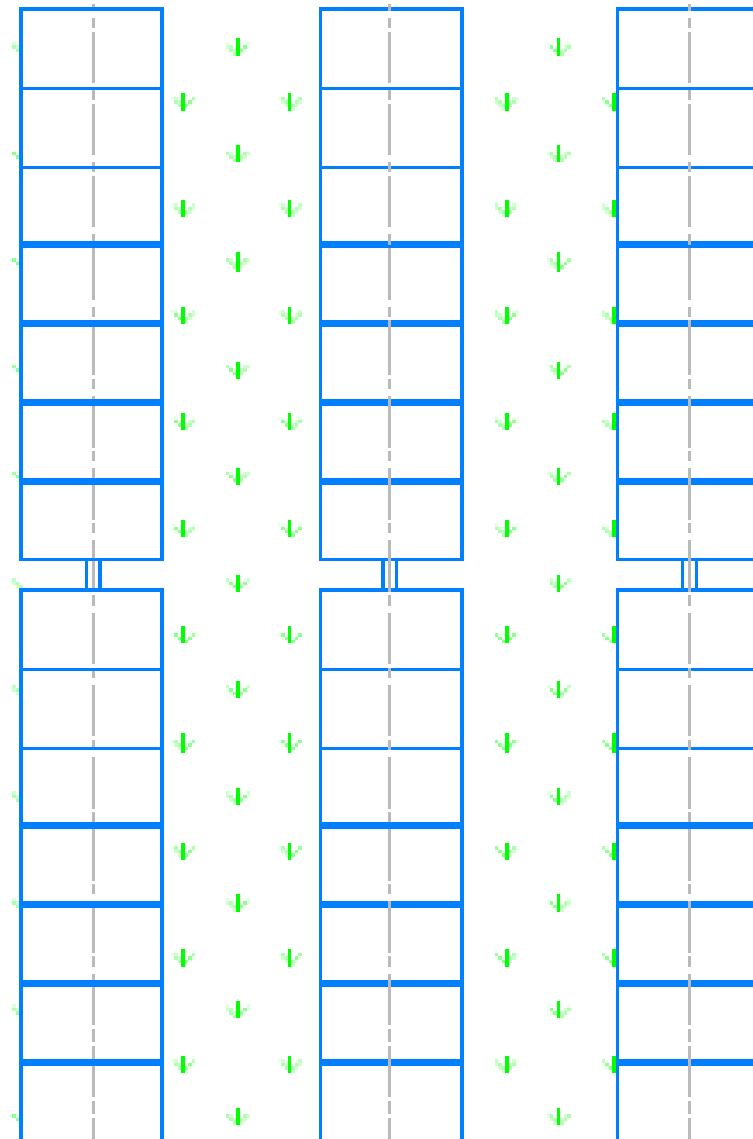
Piantumazione tra le file di tracker (vista dall'alto)
